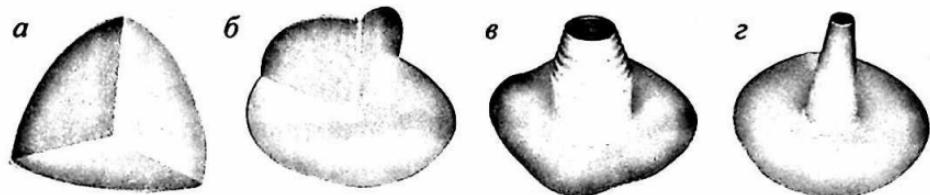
Стандартные фасонные элементы для обустройства примыканий кровли из полимерных мембран:
